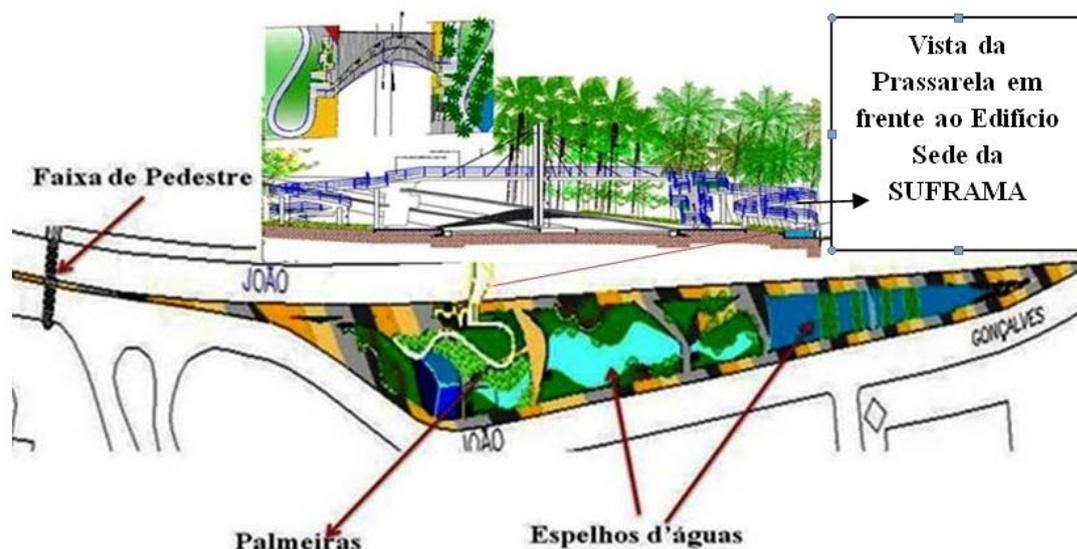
Planta de Layot da 6ª parte. Área enfrente a SUFRAMA (trecho 06).
